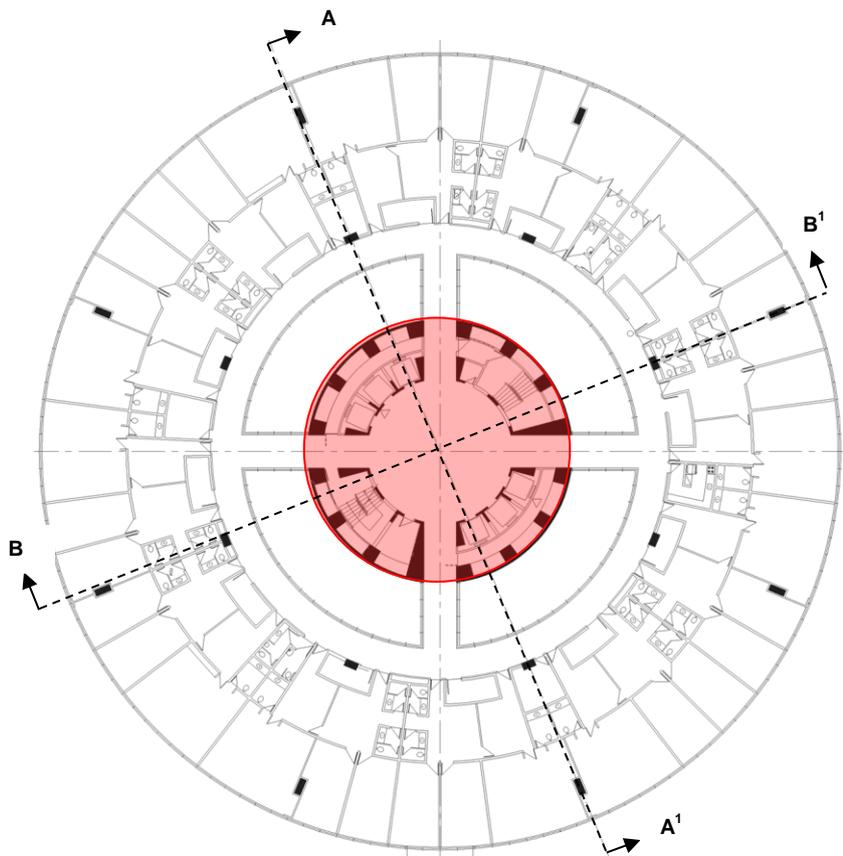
Núcleo rígido contendo a circulação vertical. Fonte: Arquivo da PGR.
